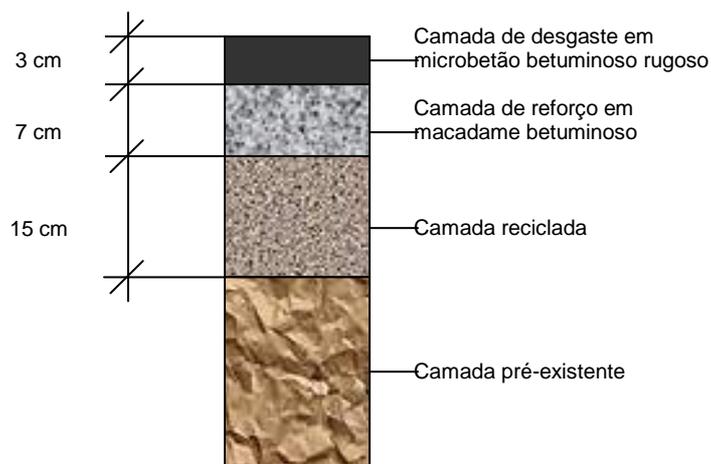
Estrutura final do pavimento rehabilitado (IP 2)
